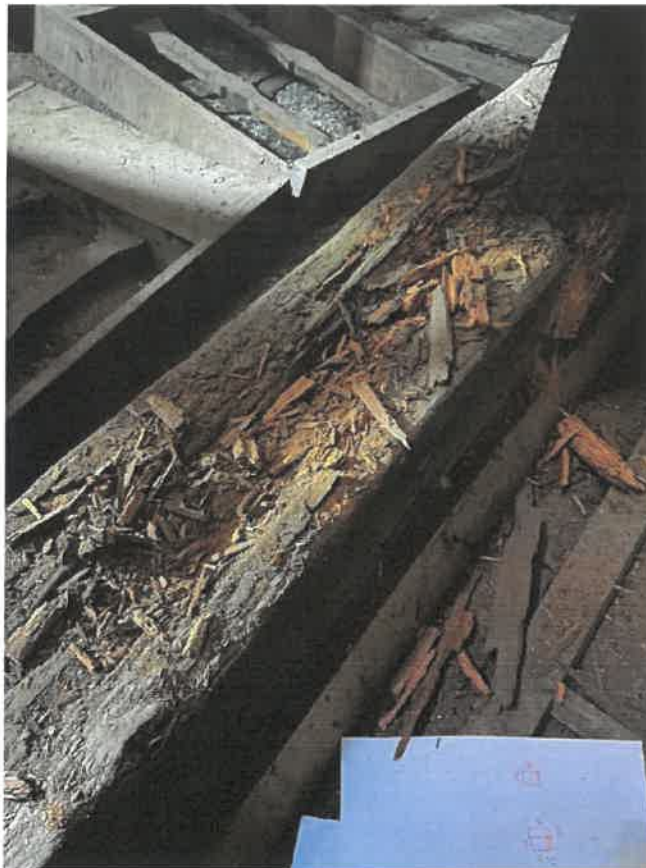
Widok otworu wlotowego oraz mączki drzewnej.
